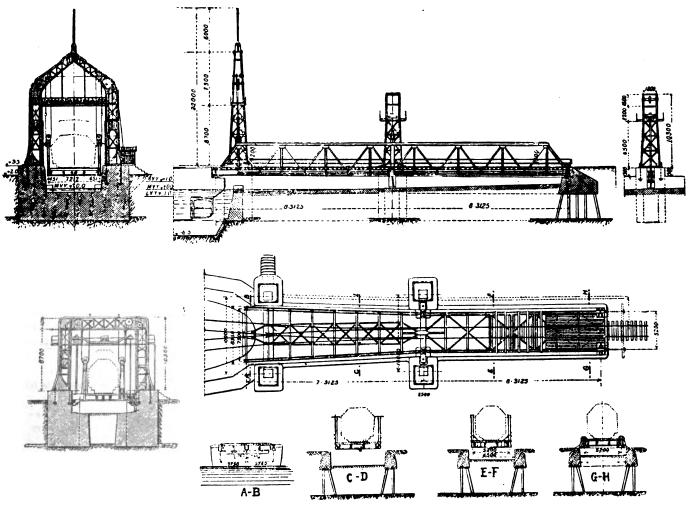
a 30 - Pontile d'approdo - Elevazioni, piante e sezioni.
